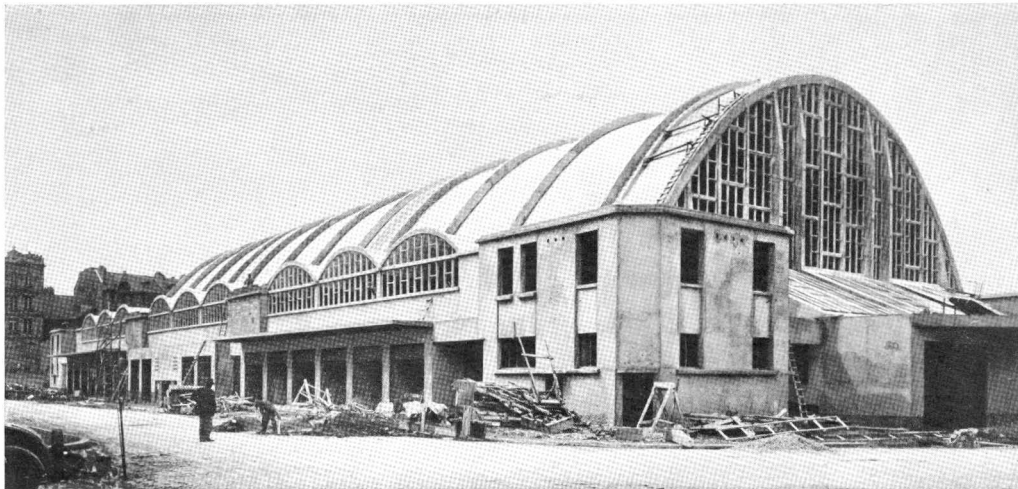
Ausstellungshalle Brünn („Ferrobeton“, Brünn)
